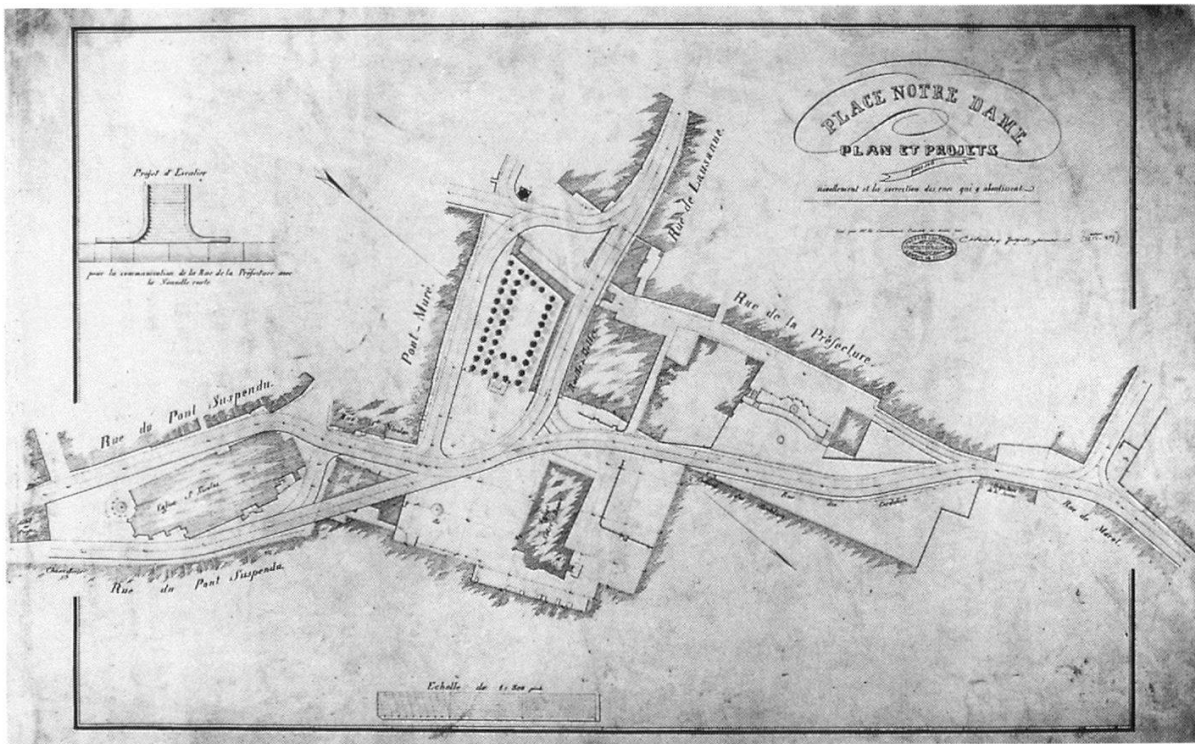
Liebfrauenplatz, Situationsplan mit neuprojektierten Straßenführungen, 1852–1859 (StAF, Bauplan Nr. 395,4).
